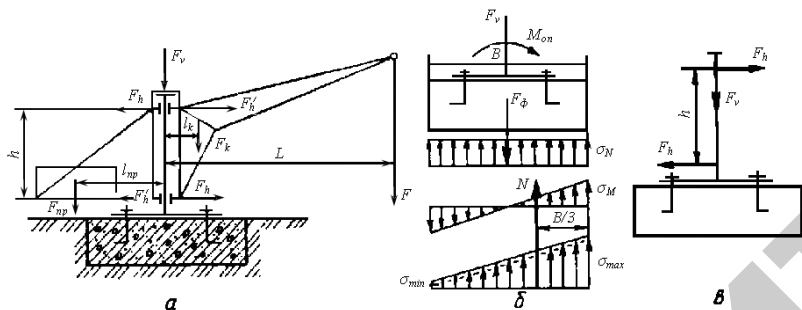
Схема полноповоротного стационарного крана на неподвижной колонне: а – для расчета противовеса; б, в – для расчета фундамента
